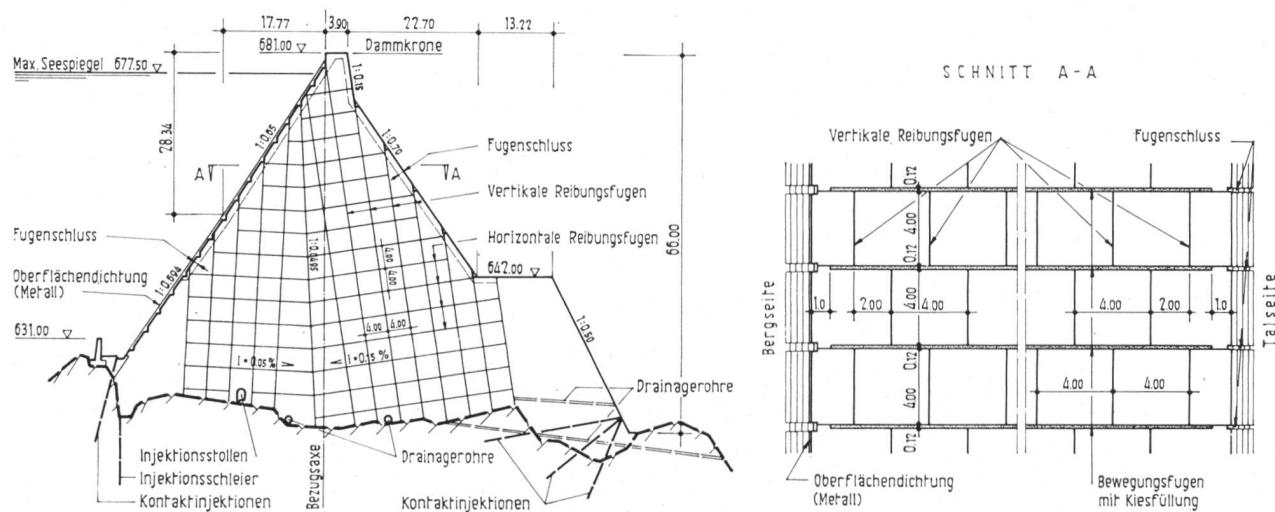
Platani-Damm, Sizilien. Vertikal- und Horizontalschnitte eines aus Betonblöcken aufgebauten Rockfill-Damms.
